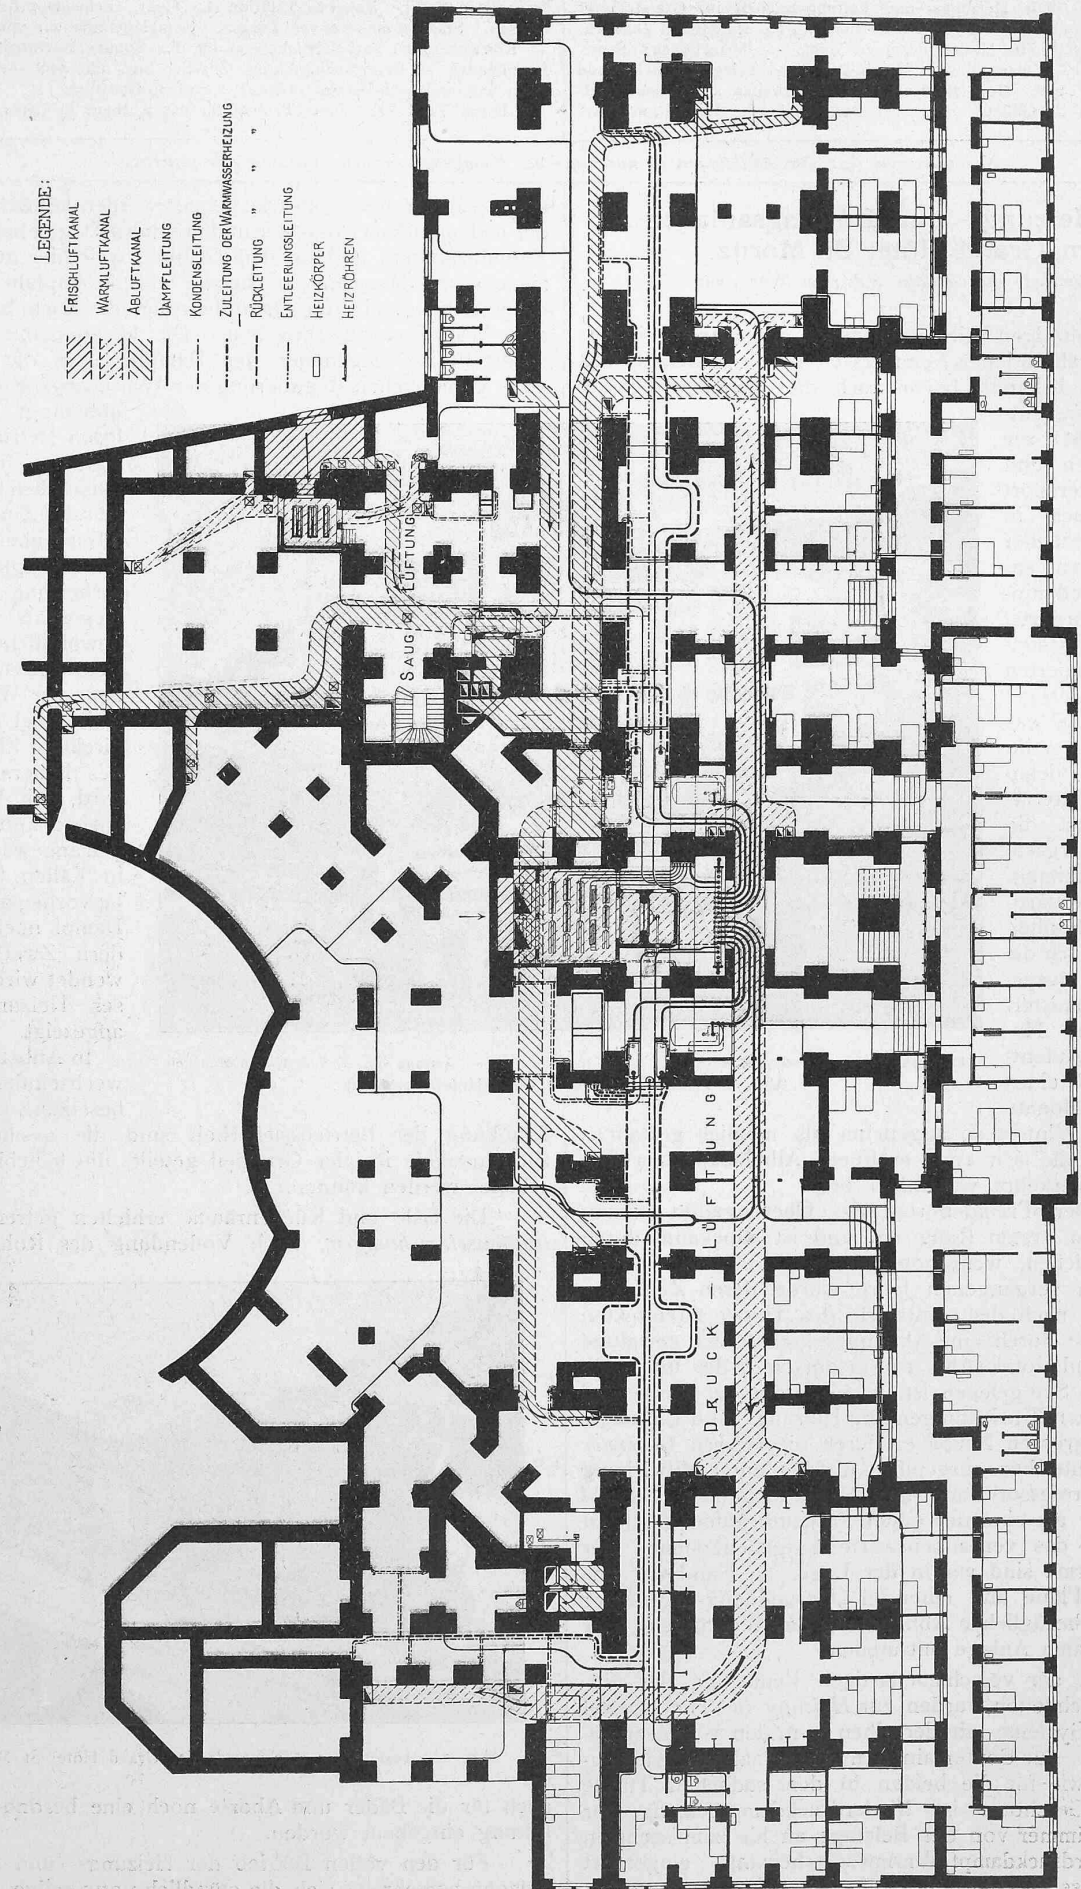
Grundriss vom Untergeschoss. — Masstab 1 : 400.
